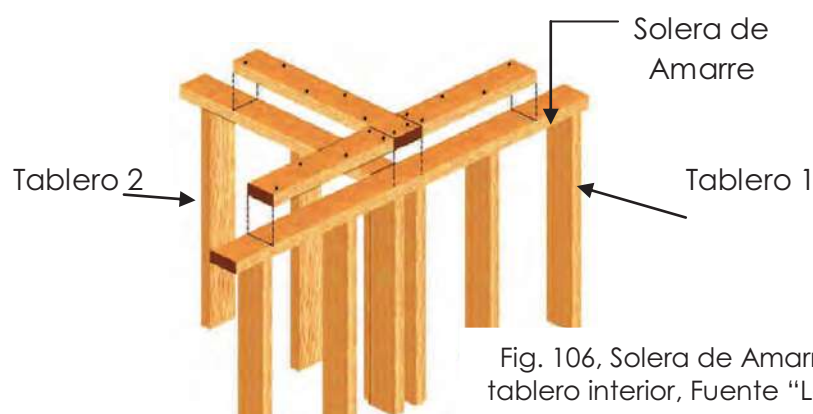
, Solera de Amarre uniendo tablero perimetral y tablero interior, Fuente "La Construcción de Viviendas en
